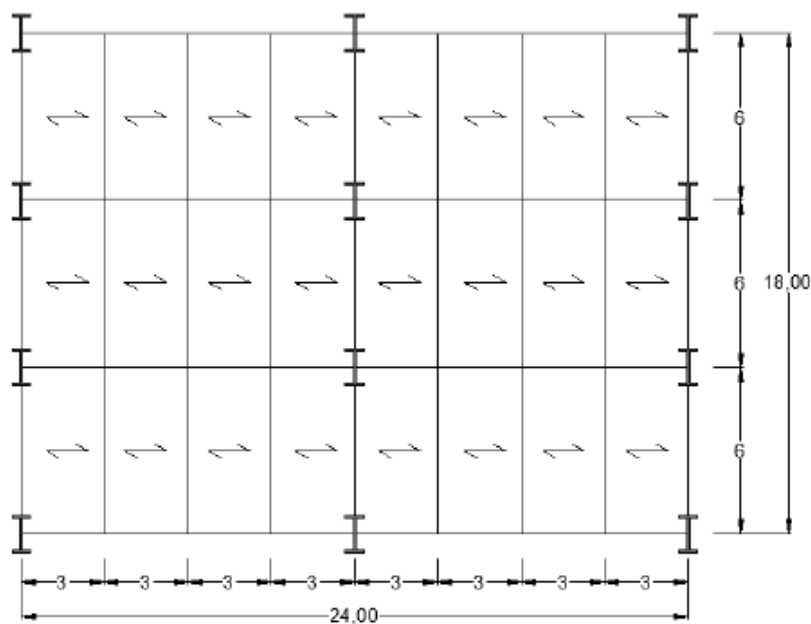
Esquema estrutural do caso 2 para a estrutura C (Fonte: Sandes, 2019)
